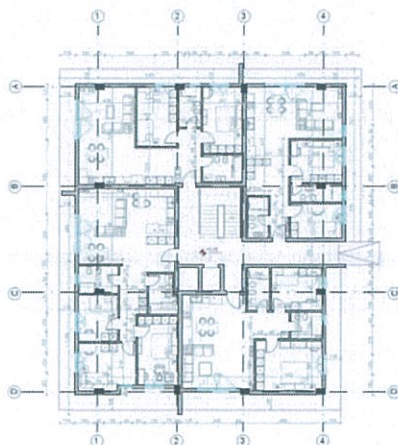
Planimetria e katit perdhe e objekteve te banimit
